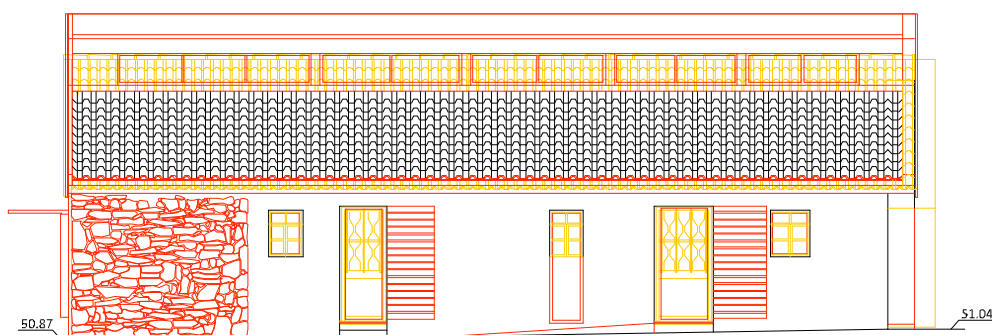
Alçado Sueste – elementos a manter, a retirar e a construir
